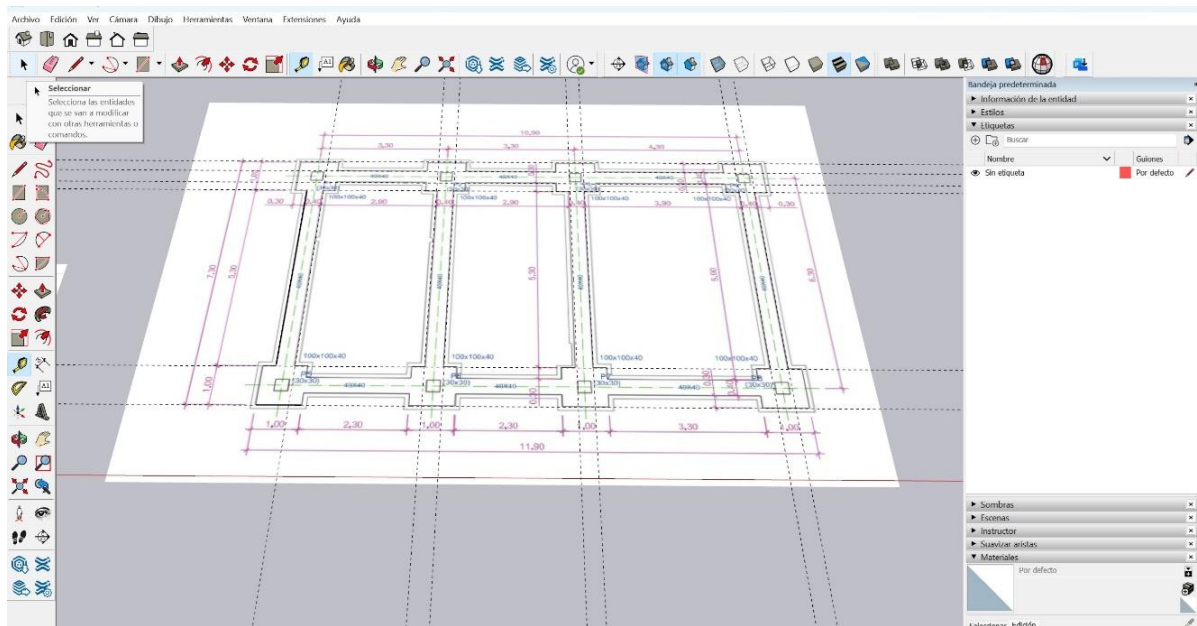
INSERION DE PLANO DE CIMENTACION EN SKETCHUP
